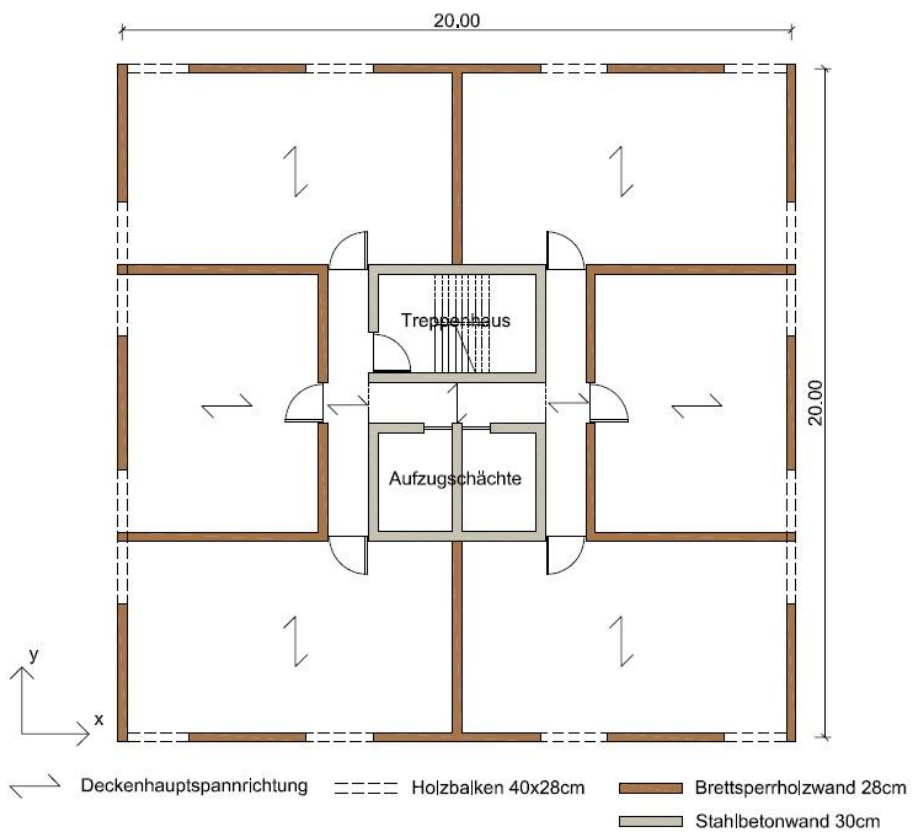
Grundriss der Hybridkonstruktion
